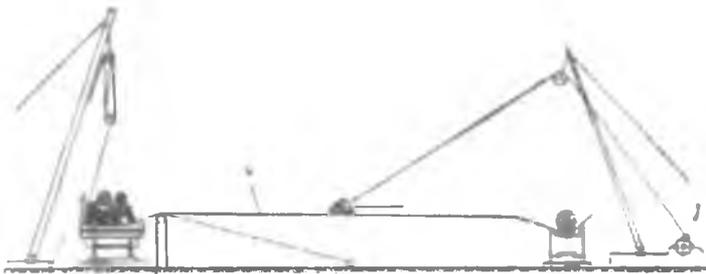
Схема перегрузочной площадки с лебедкой:
